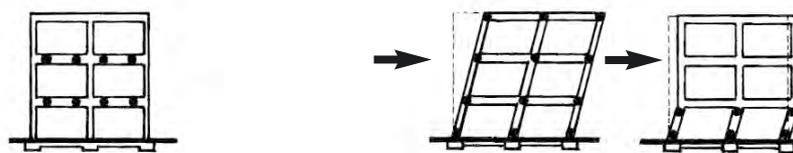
Rupture fragile des poteaux et des poutres entraînant l'effondrement de l'ouvrage (séisme de Spitak, Arménie, 7.12.1988).
